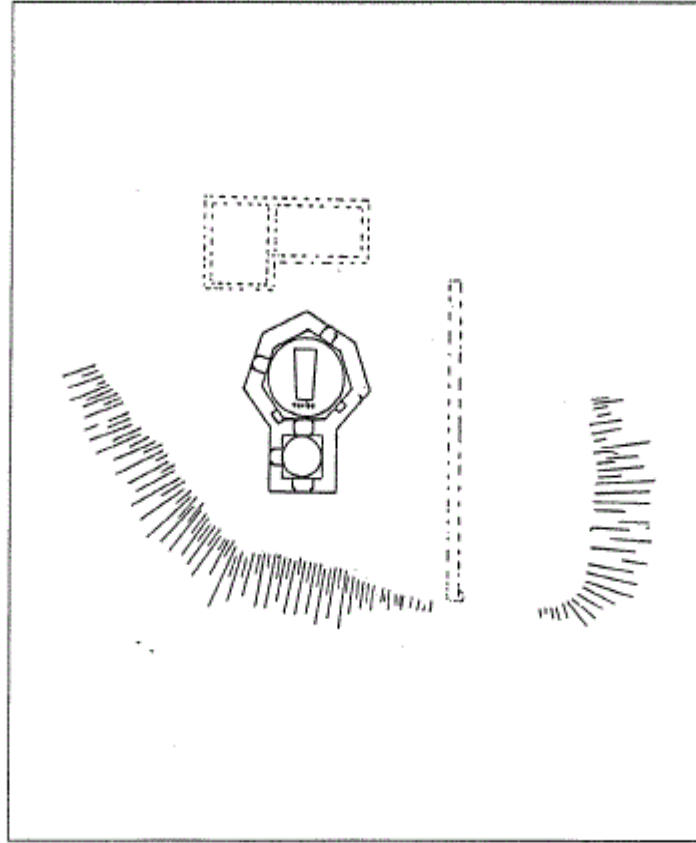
مسقط أفقي لثروة السليمانية بإستانبول (عن : اصلان ابا) .
